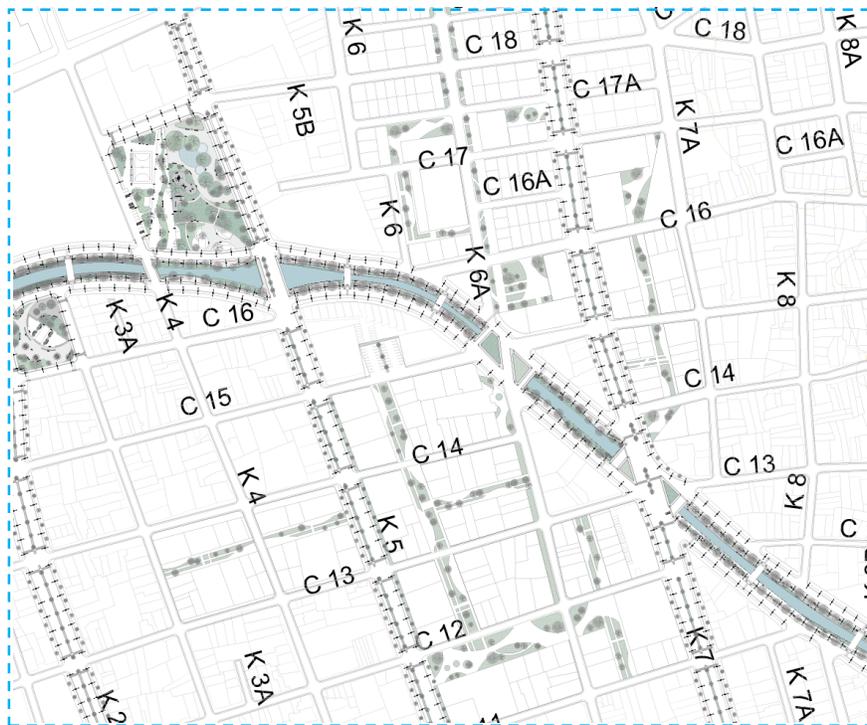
Plano General – Propuesta Urbana Sección 2
